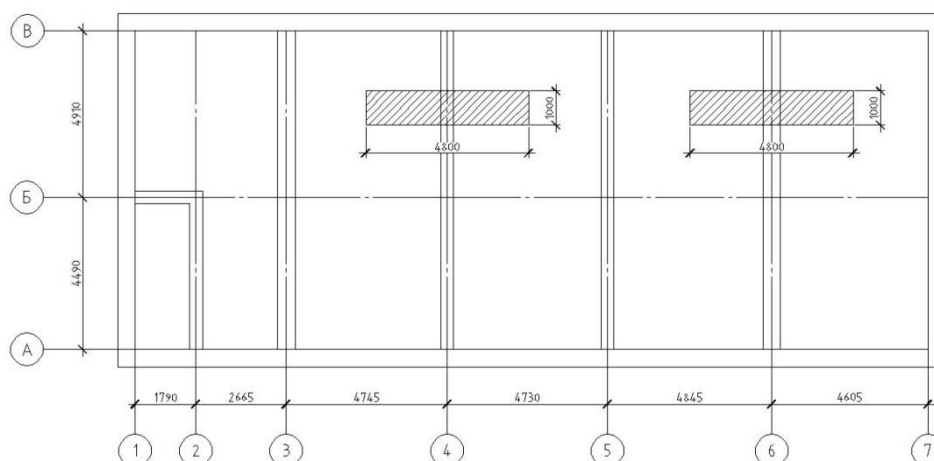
Схема грузовой площади для сбора нагрузок
